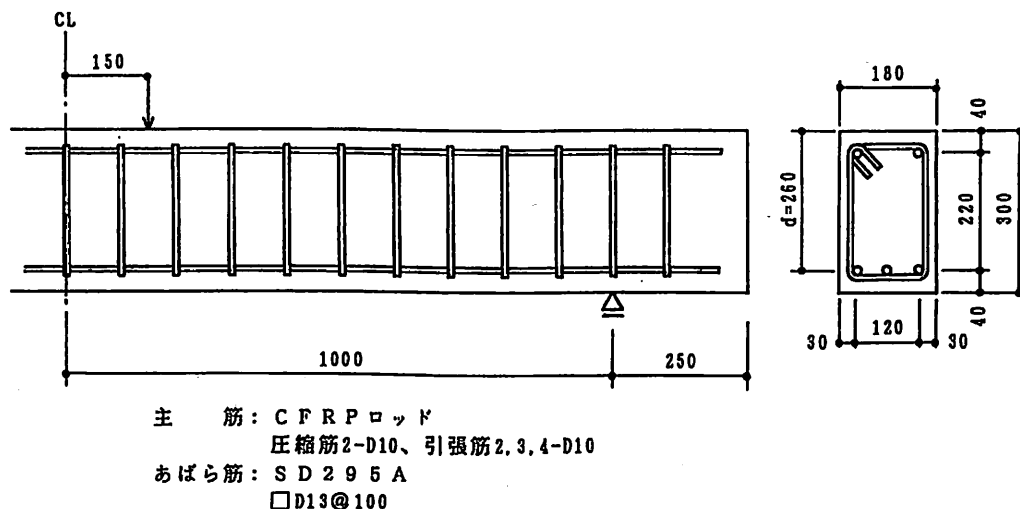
連続繊維補強コンクリート梁の断面形状寸法及び配筋
